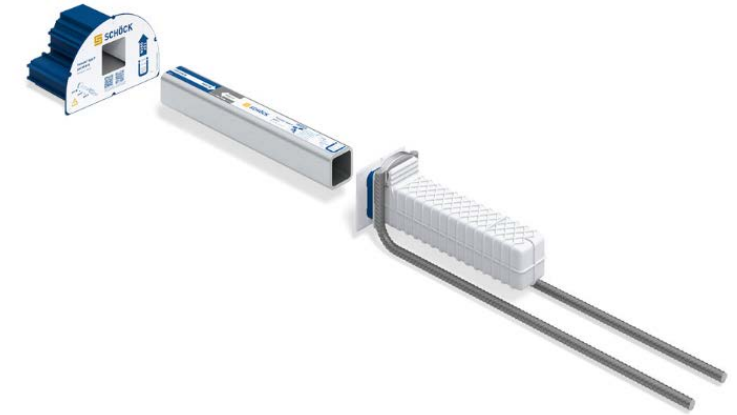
Schöck Tronsole® Typ P: Einbauschritt mit Ortbetonpodest und Luffuge
